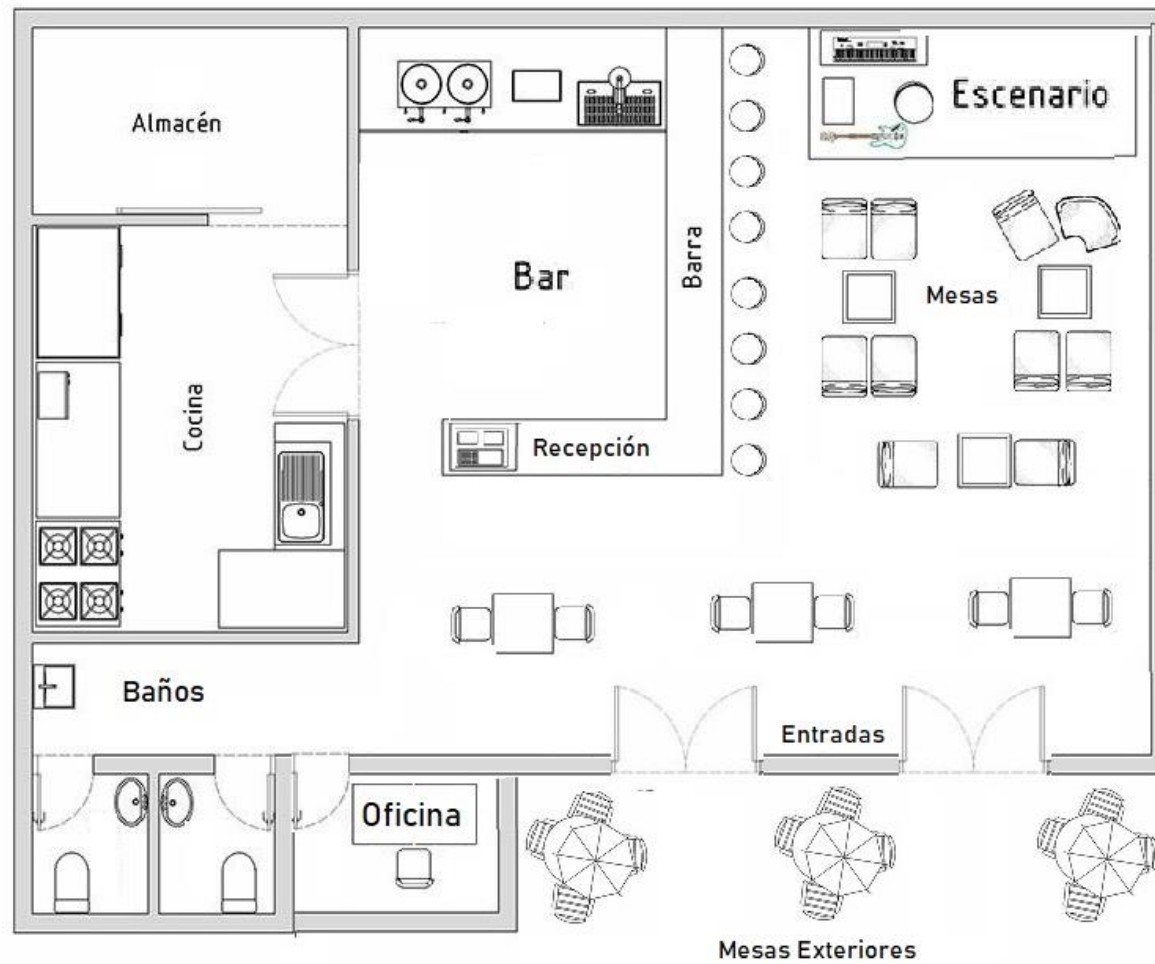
Plano de planta física Restaurante Bar. Fuente: Elaboración Propia
